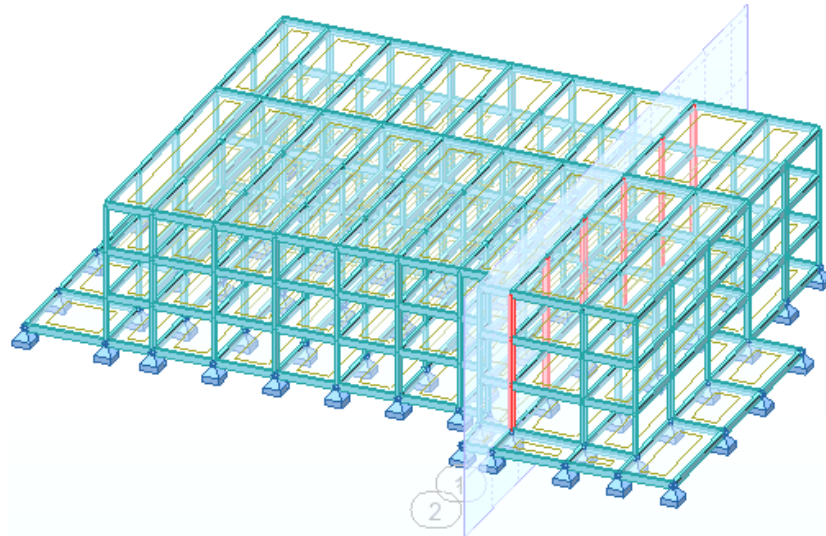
Plano que interceta os pilares que descarregam na viga B7
